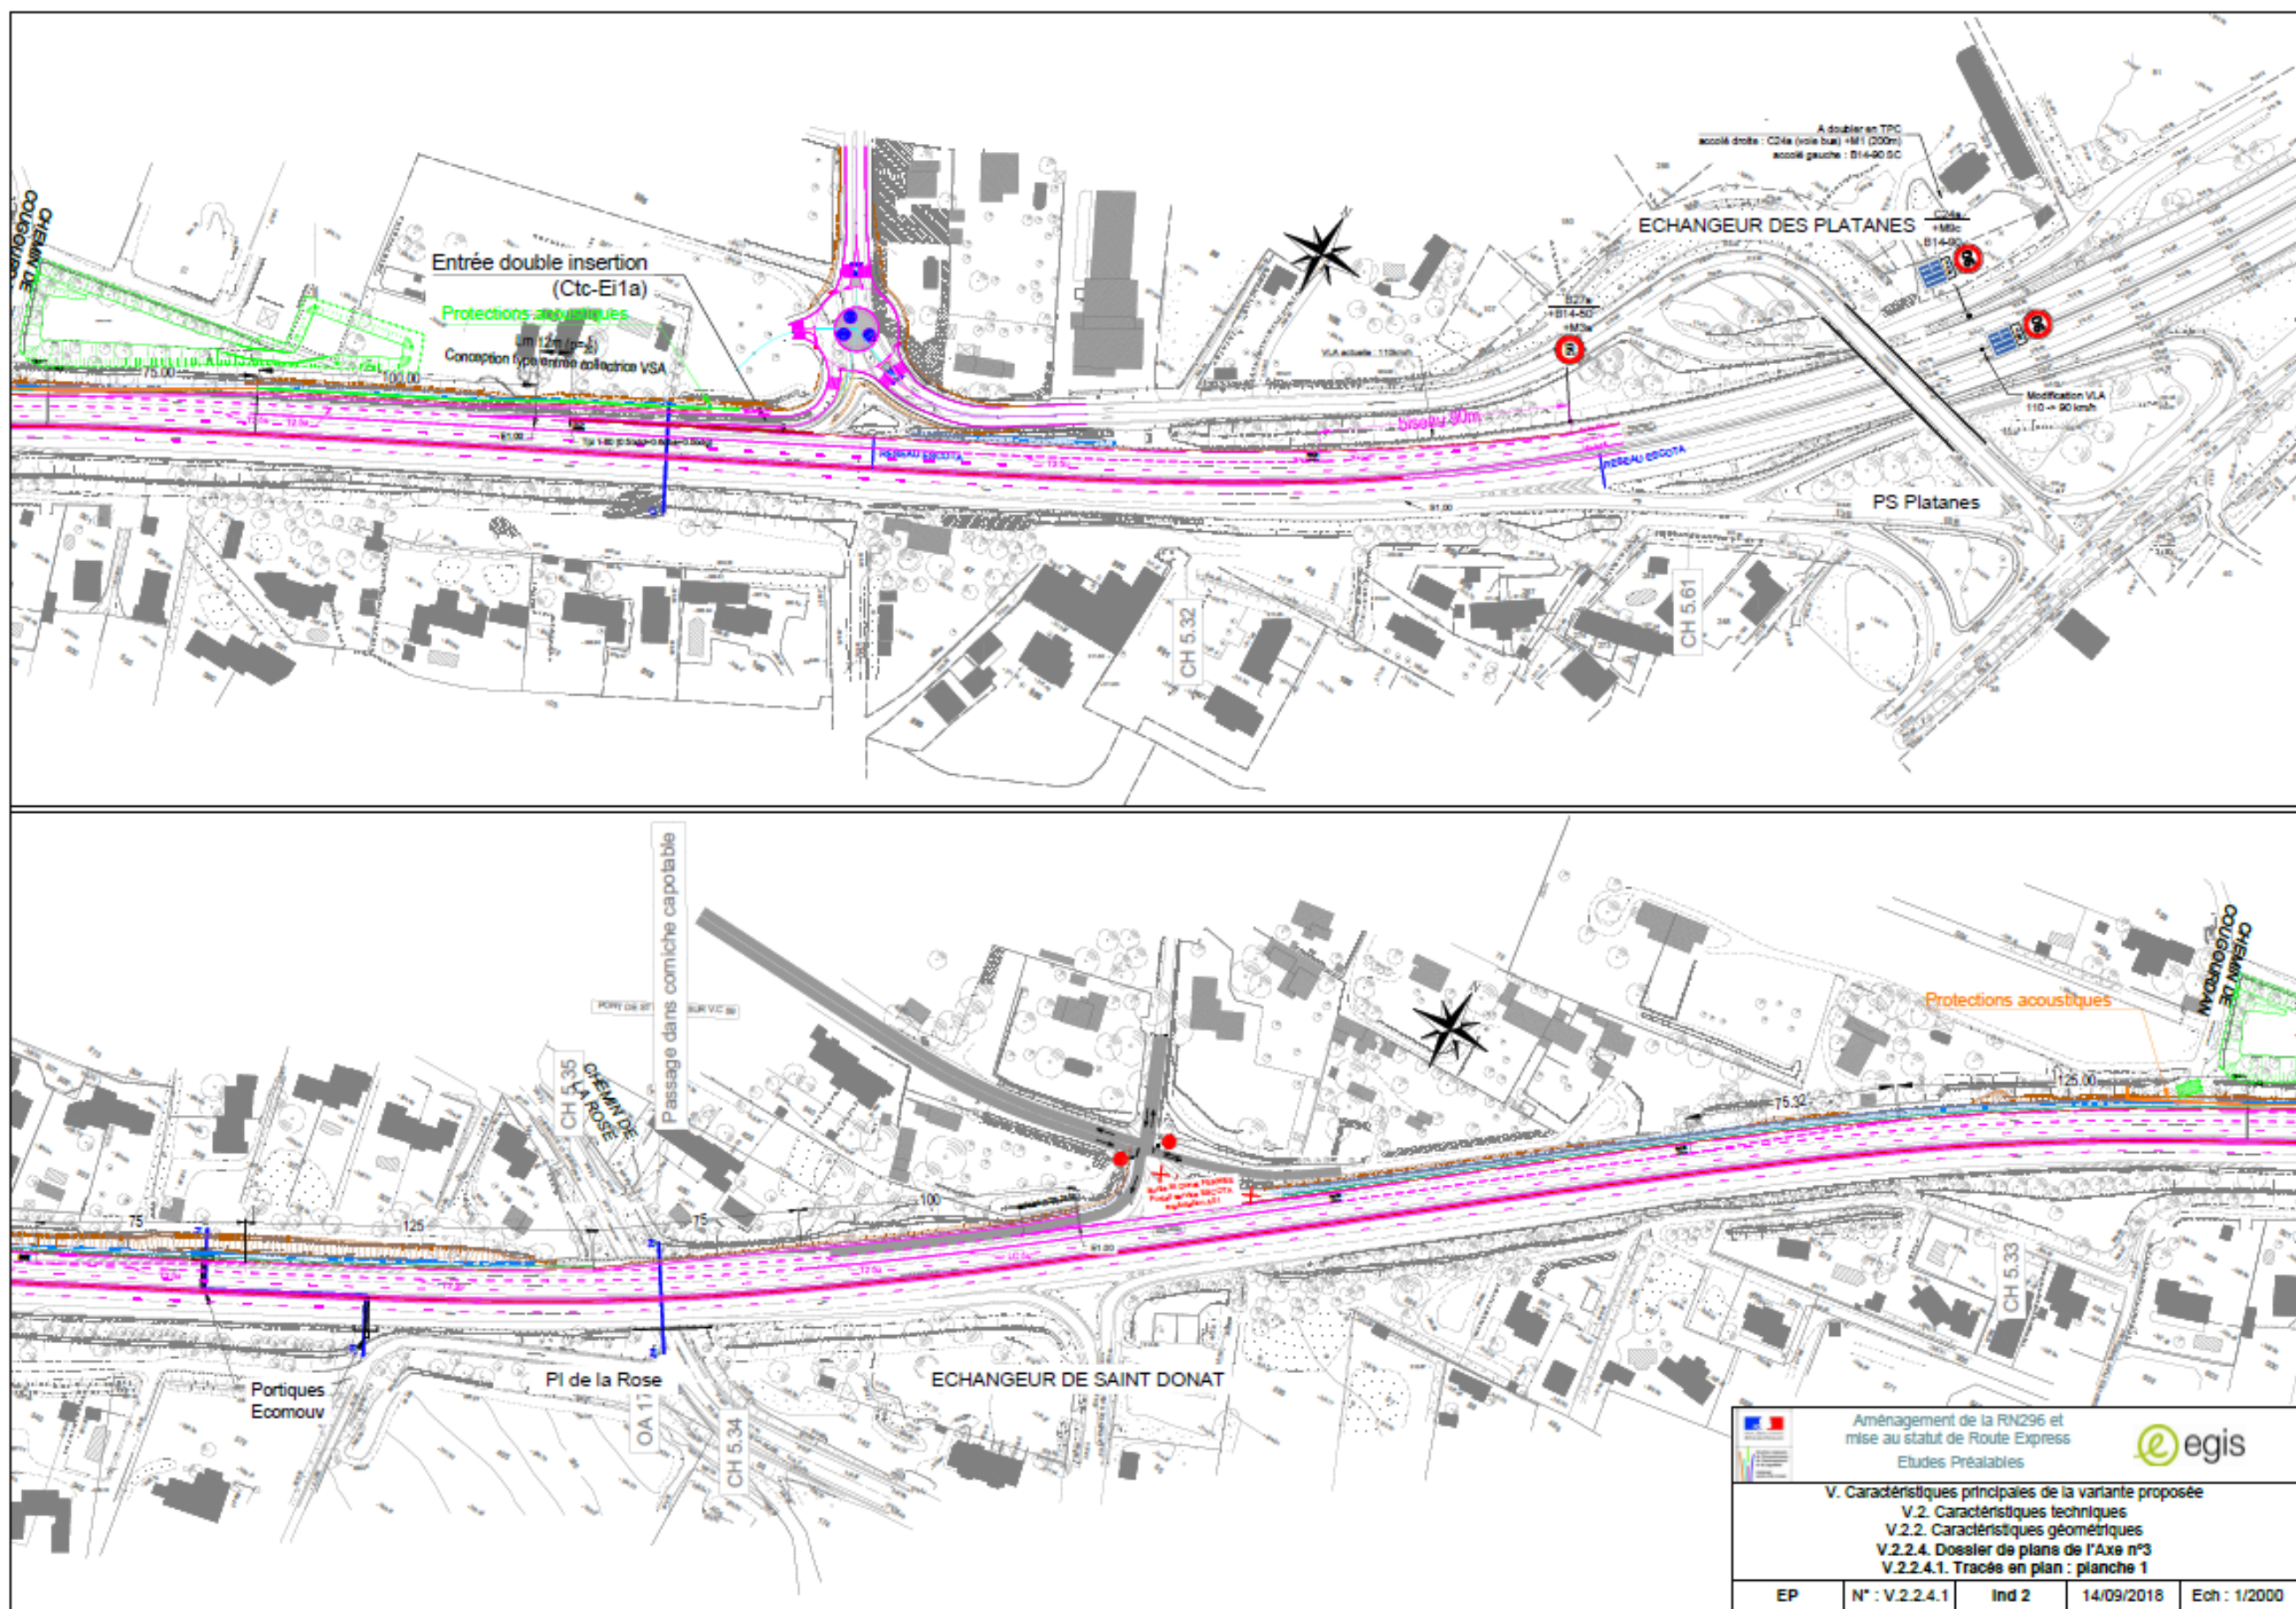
Vue en plan de l'aménagement de l'axe 3 – planche 1
